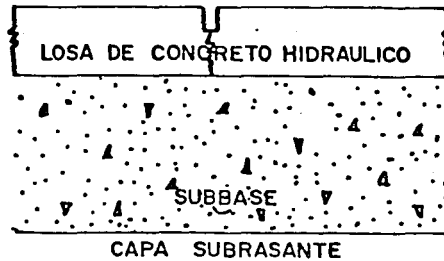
Esquema que muestra las capas que forman un pavimento rígido, que se construye sobre la capa subrasante.
